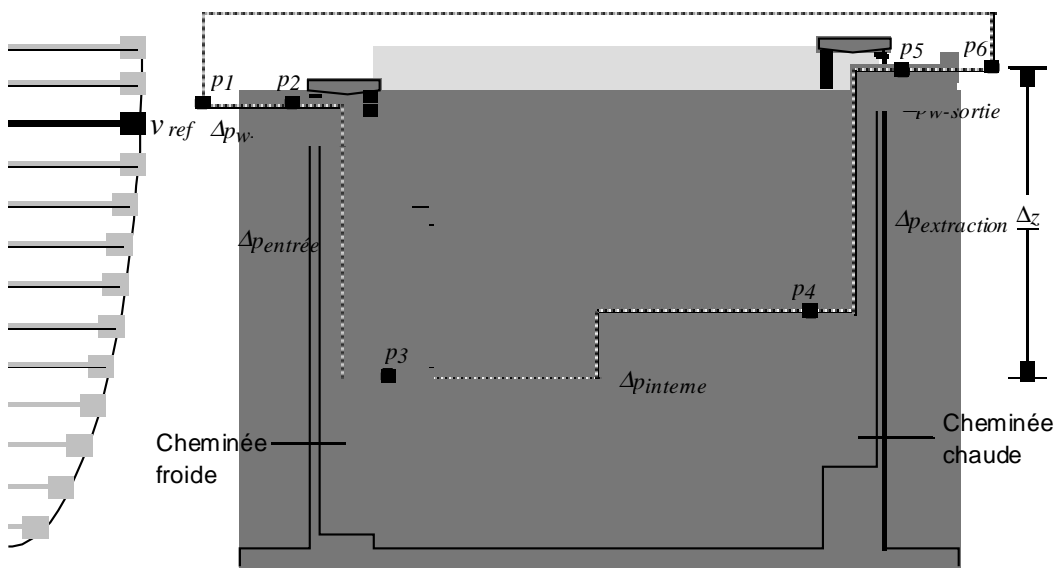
12: Ventilation naturelle par équilibrage de conduits
